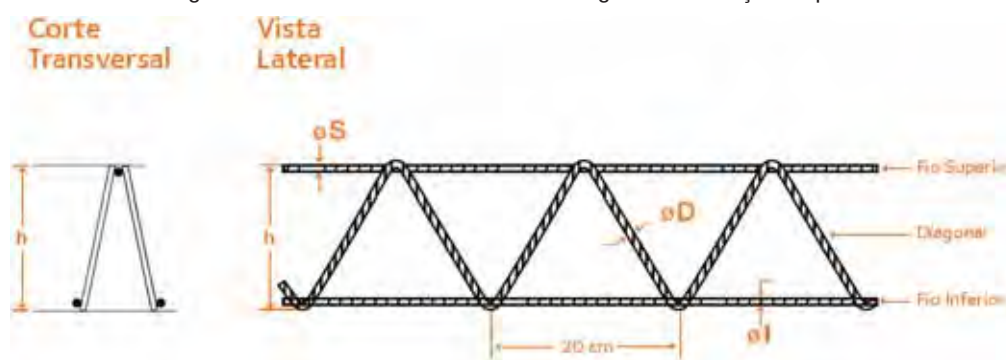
Seção transversal de laje pré-moldada treliçada
